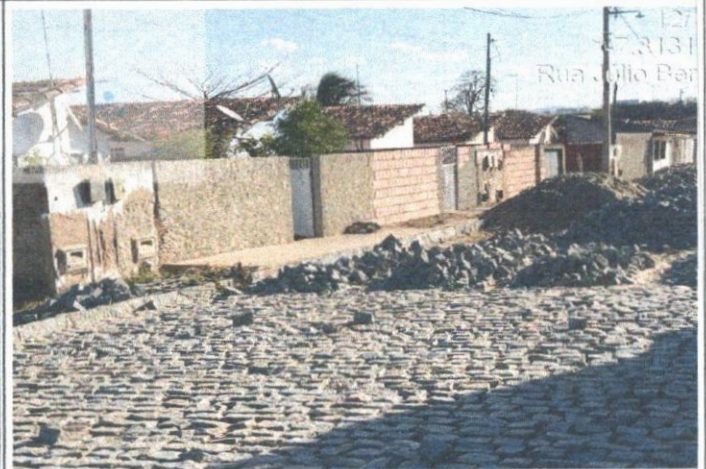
EXECUÇÃO PAVIMENTAÇÃO
